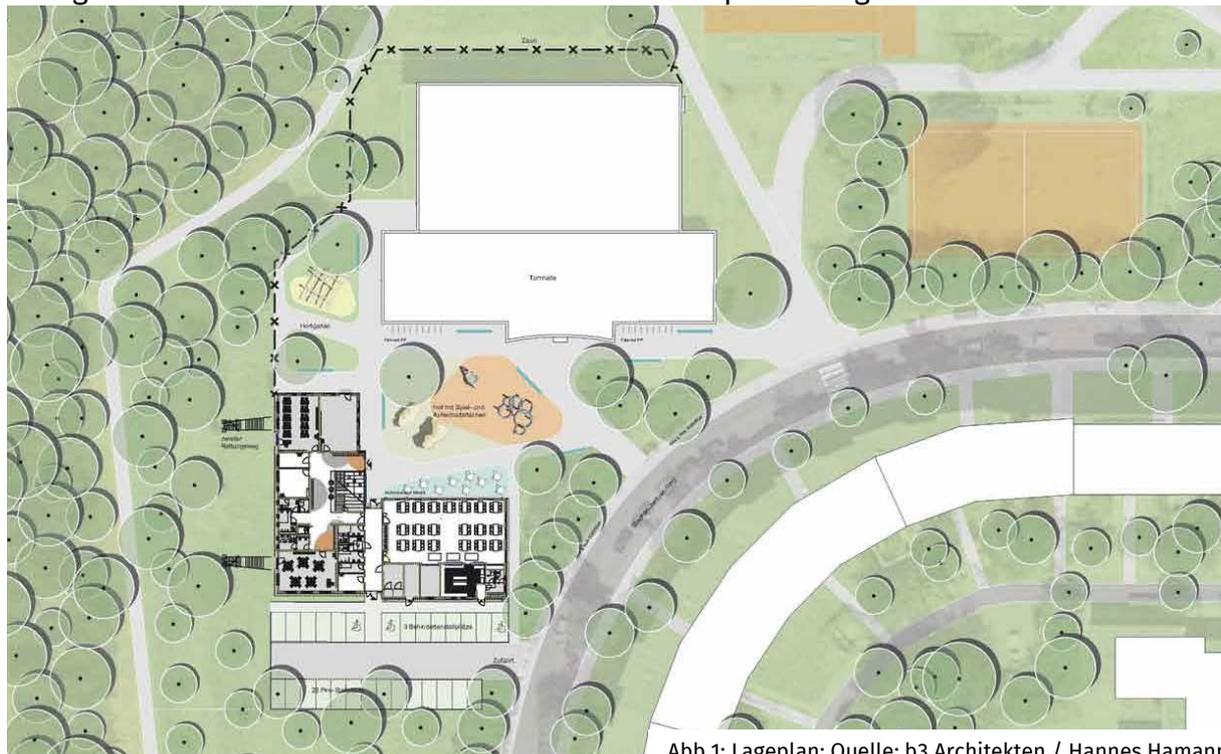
Lageplan; Quelle: b3 Architekten / Hannes Hamann
